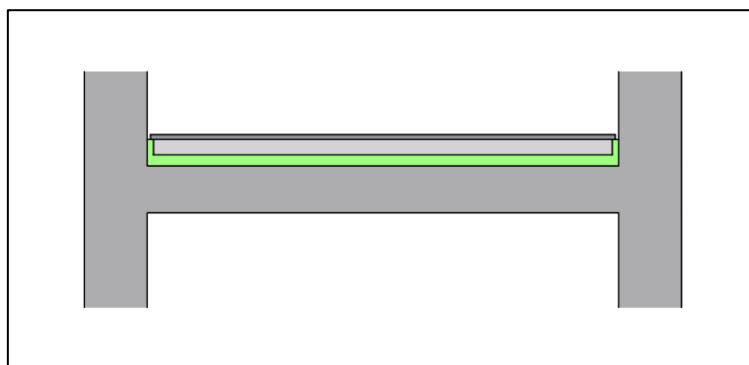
Schema grafico massetto flottante. Elaborazione propria.
